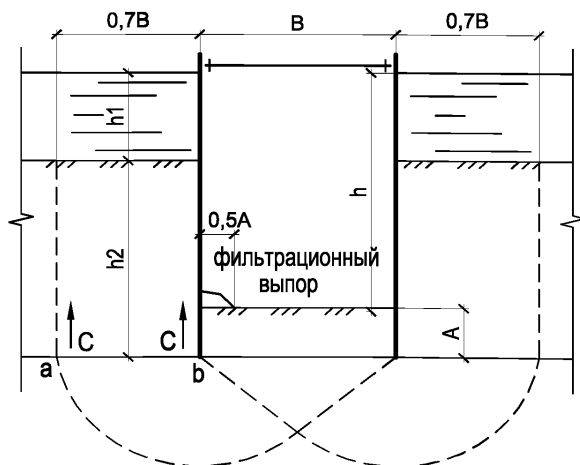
Расчетная схема к проверке дна котлована на выпучивание
